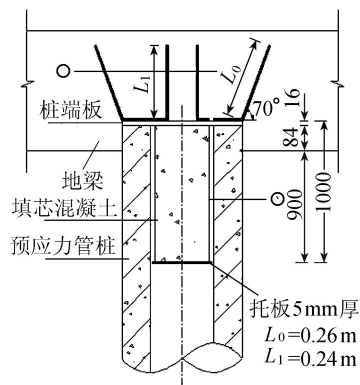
预应力管桩与地梁连接示意图(尺寸单位:mm)
